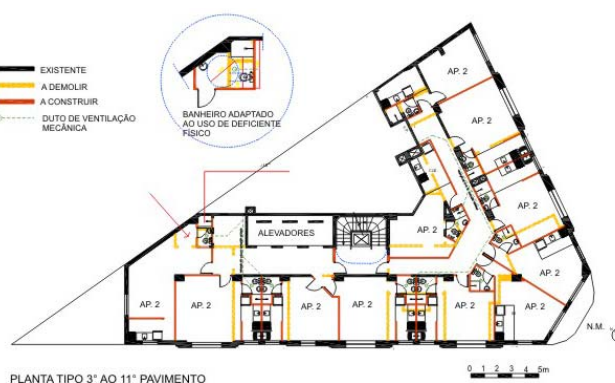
Planta 3º ao 11º pavimentos Edifício Riskallah Jorge
